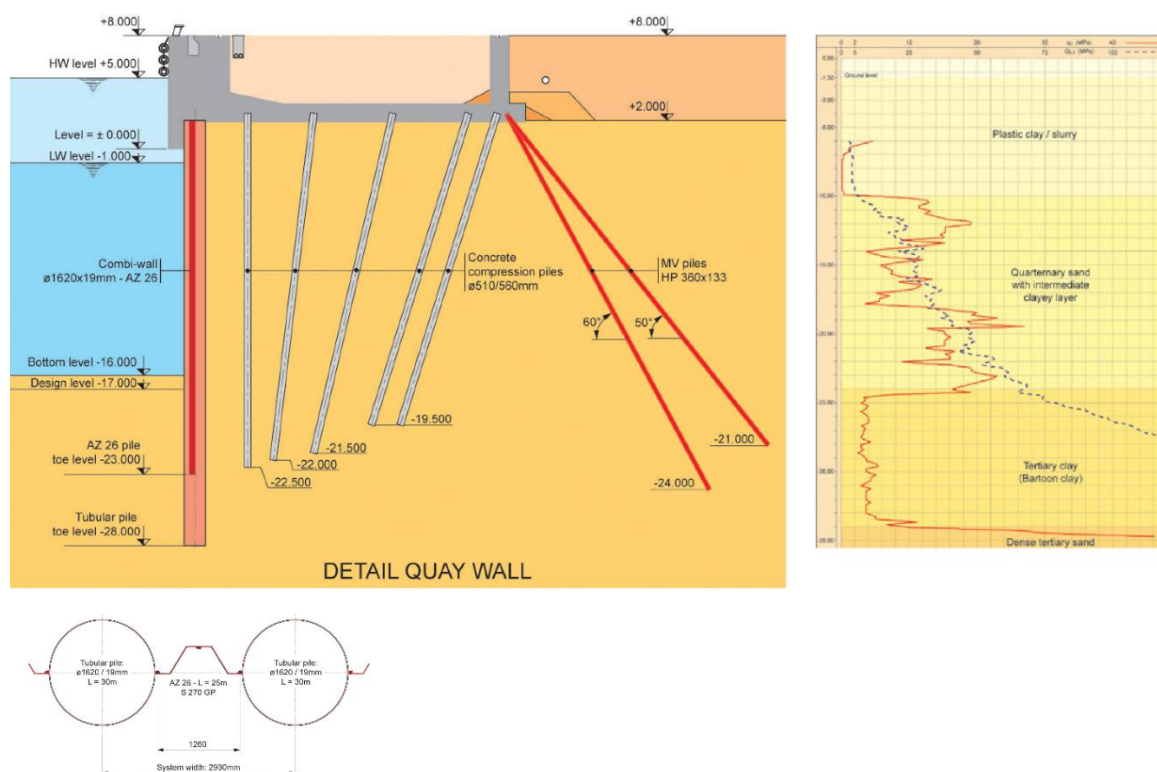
Solução adotada, perfil e planta da cortina e ensaio CPT – Fonte na ficha
